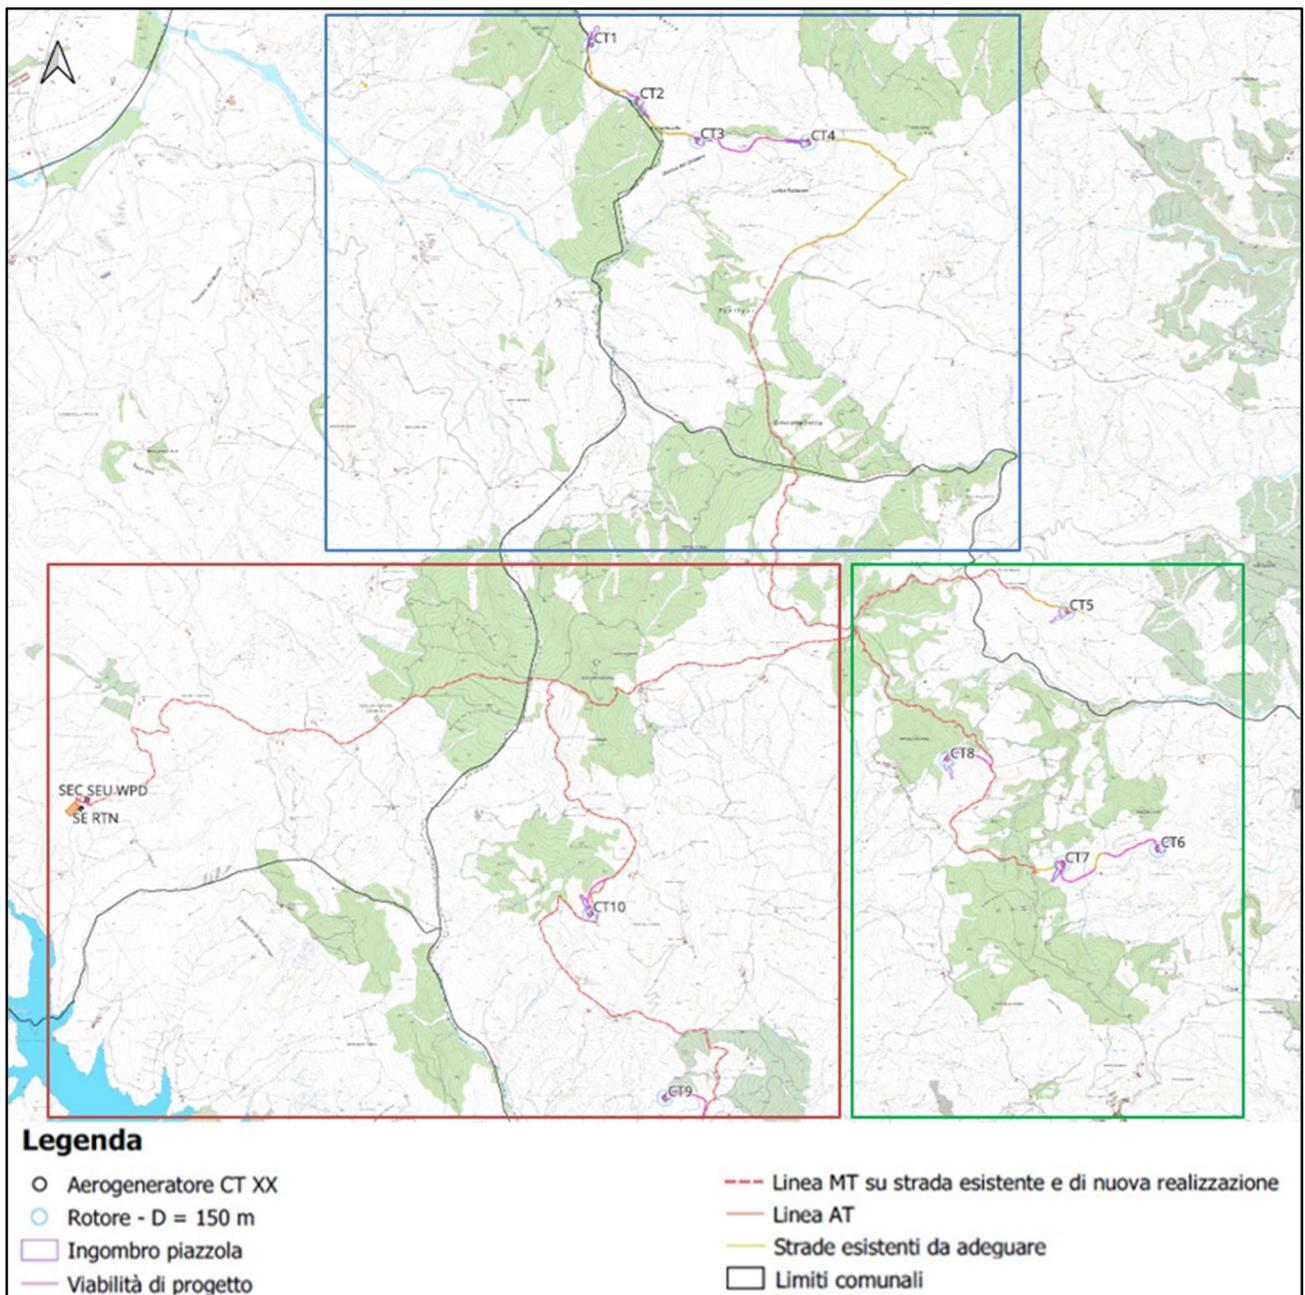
Layout d'impianto suddiviso in zone su CTR: Zona 1, rettangolo rosso – Zona 2, rettangolo azzurro – Zona 3, rettangolo verde
